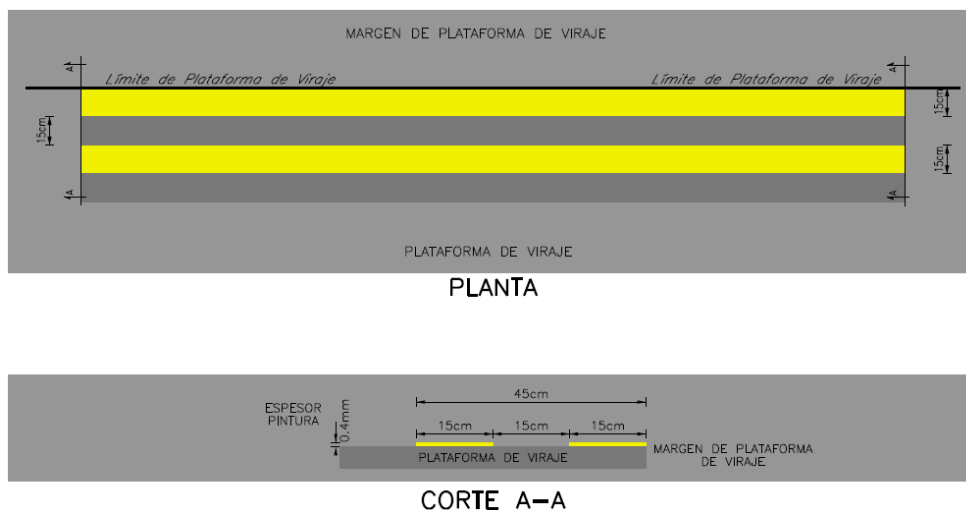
Detalles en planta y corte sobre colocación en pavimento de Señal de Borde de Plataforma de Viraje.
